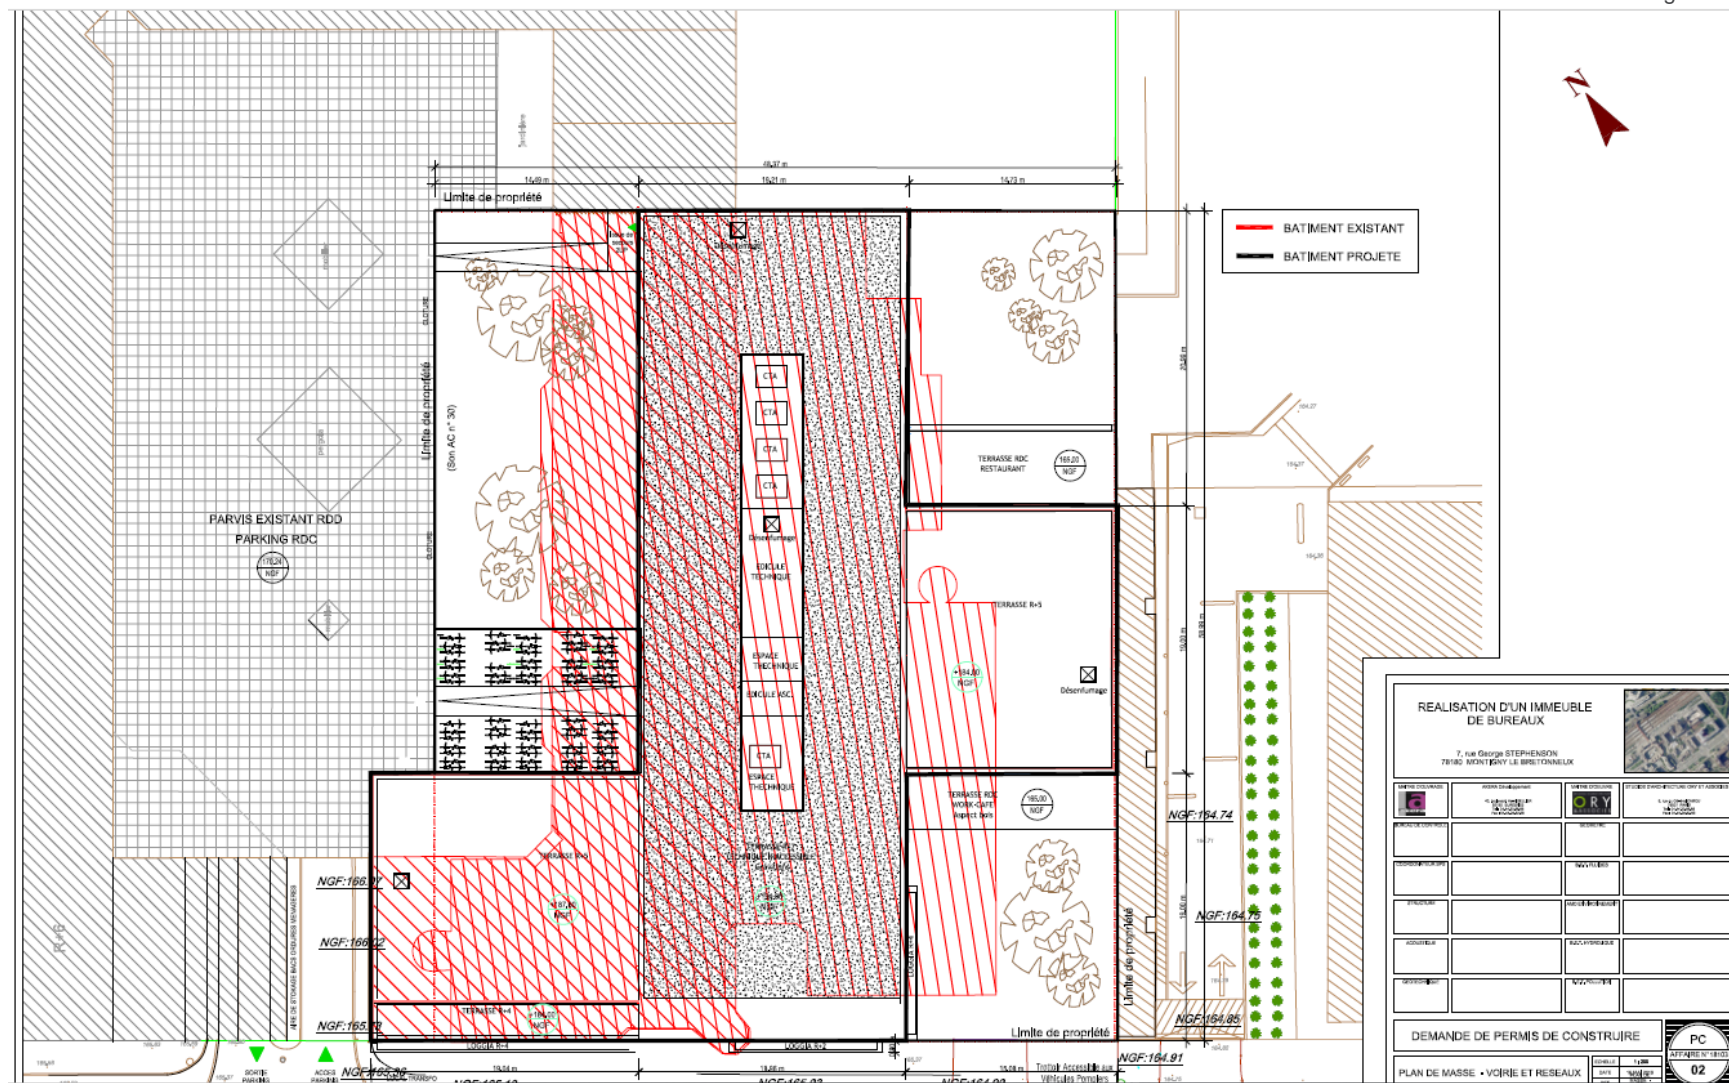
Superposition du plan masse du projet et du bâtiment existant (Source : Studios d'Architecture ORY & Associés)
